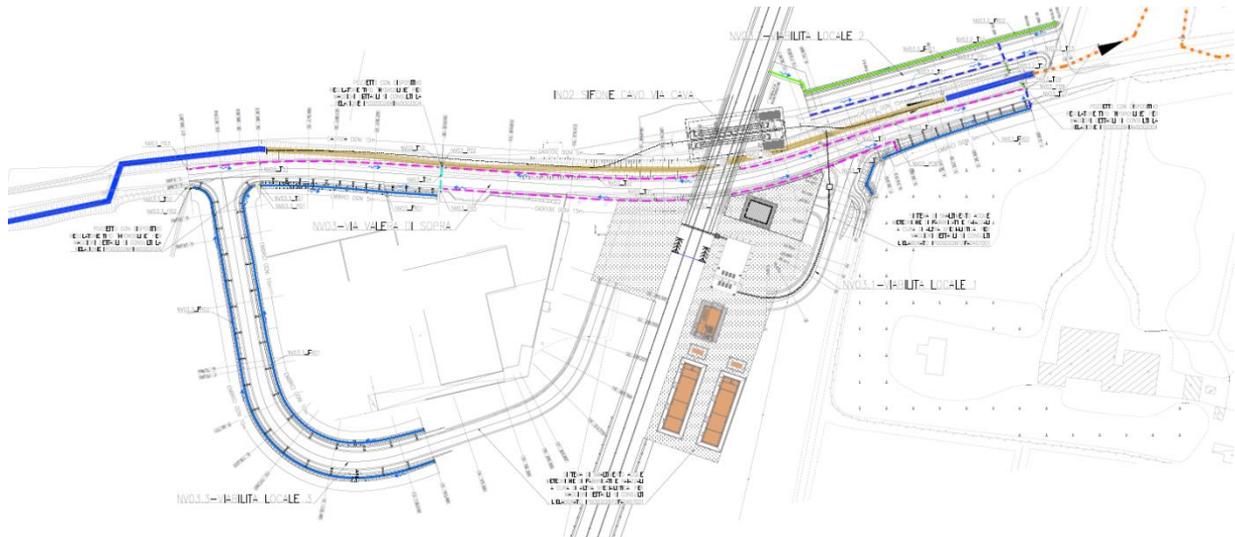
Stralcio planimetrico drenaggio viabilità NV03
